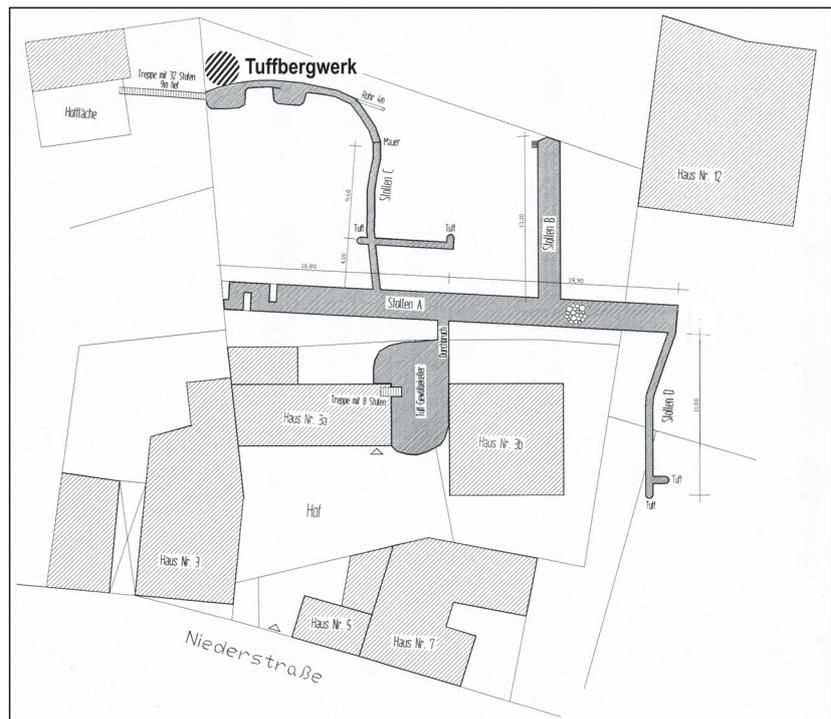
FS 53, Niederstraße. Plan der Bunker- und Kelleranlage. – (Graphik W. Horch).
